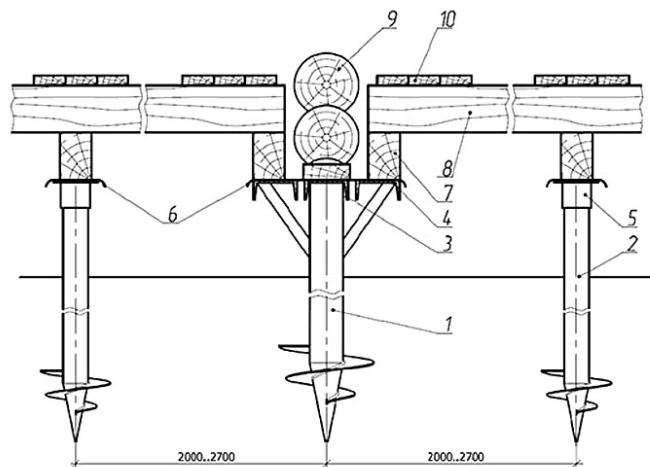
Схема монтажа свайно-винтового фундамента: 1 – винтовая свая $d = 108$ мм; 2 – винтовая свая $d = 76$ мм; 3 – швеллер обвязки; 4 – подпорка бруса обвязки; 5 – оголовок; 6 – гидроизоляция; 7 – брус обвязки; 8 – балки перекрытия; 9 – бревенчатая стена; 10 – досчатый настил
